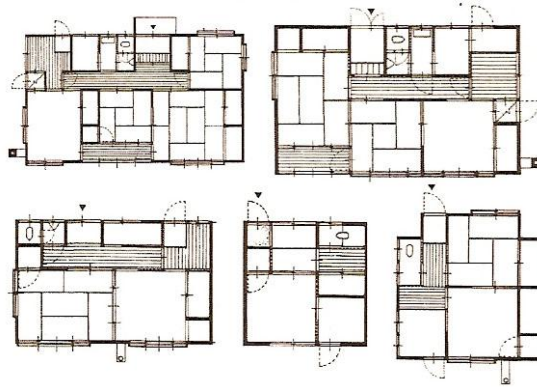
Grundriss einer Young-Dan-Wohnung
